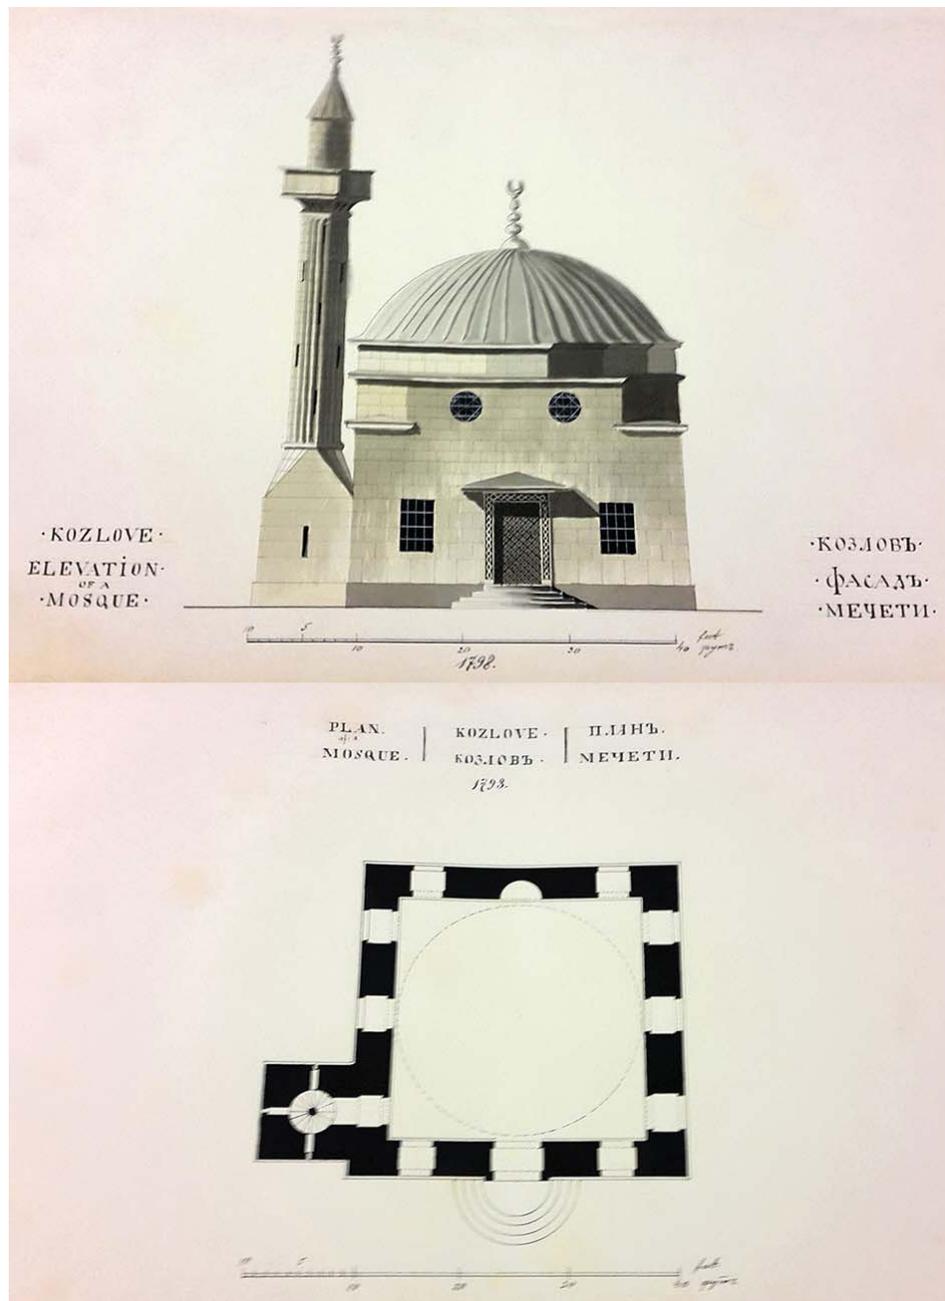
У. Хейсти. Фасад (вверху) и план (внизу) мечети в Козлове
